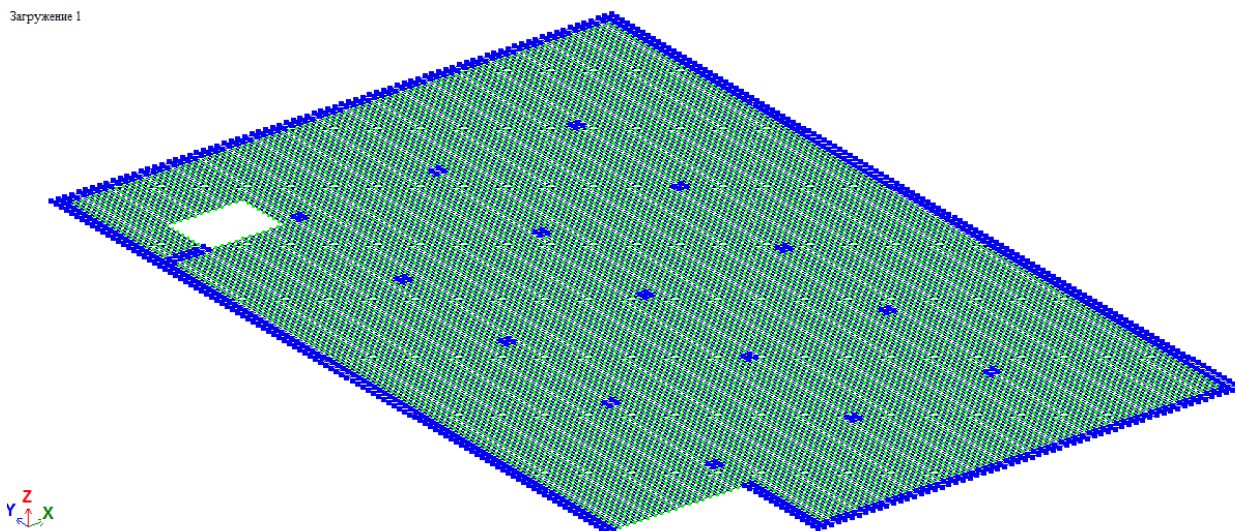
Расчетная схема плиты перекрытия с наложенными связями
